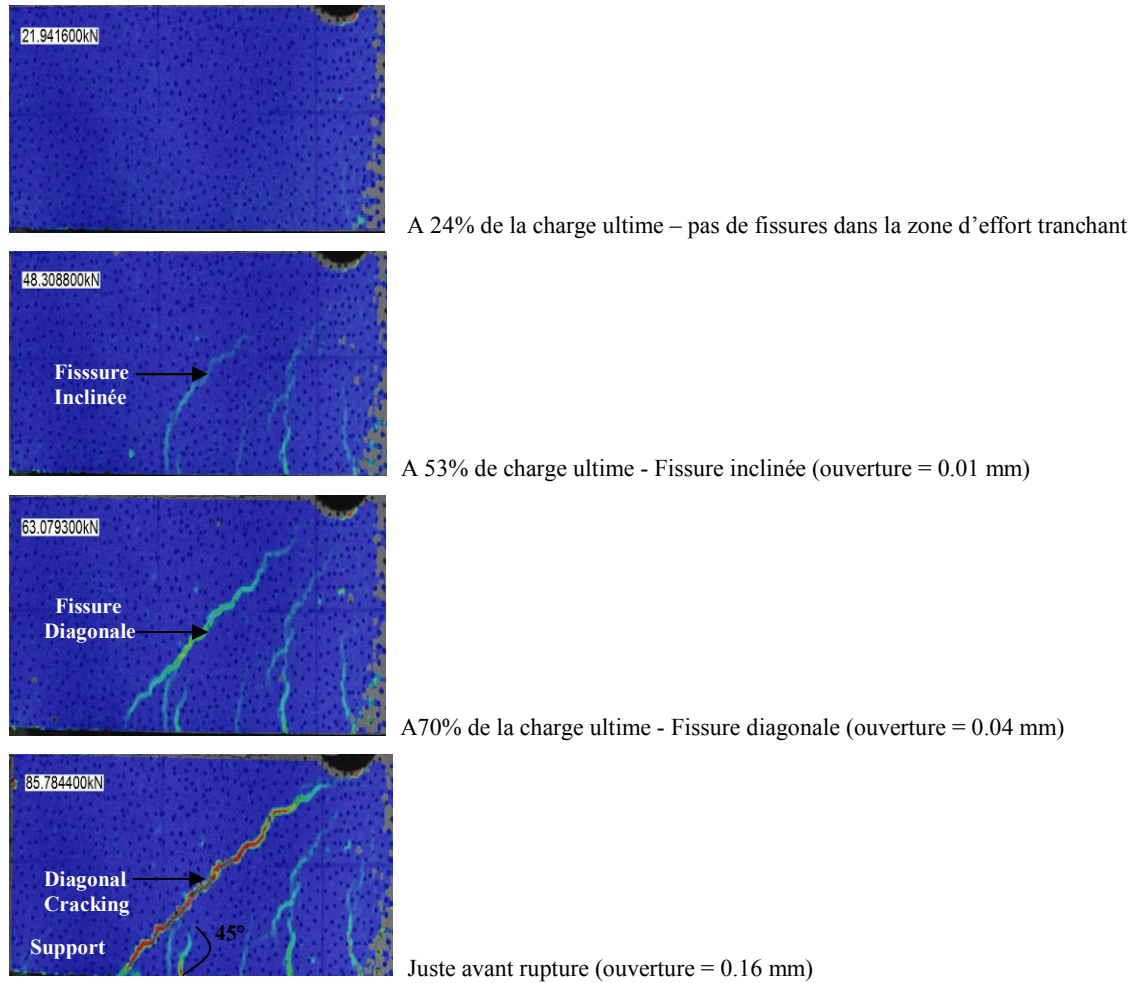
Séquence de développement d'une fissure diagonale dans la zone d'effort tranchant d'une poutre contenant des fibres d'acier
